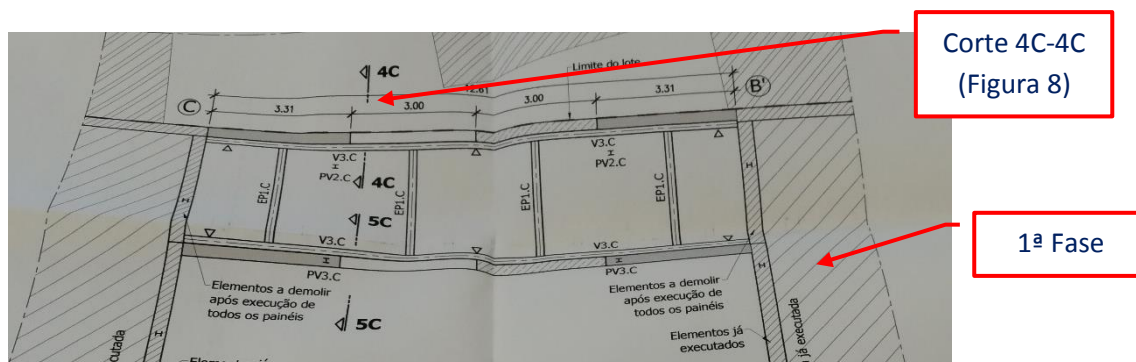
Planta da solução de contenção periférica – 2ª fase
